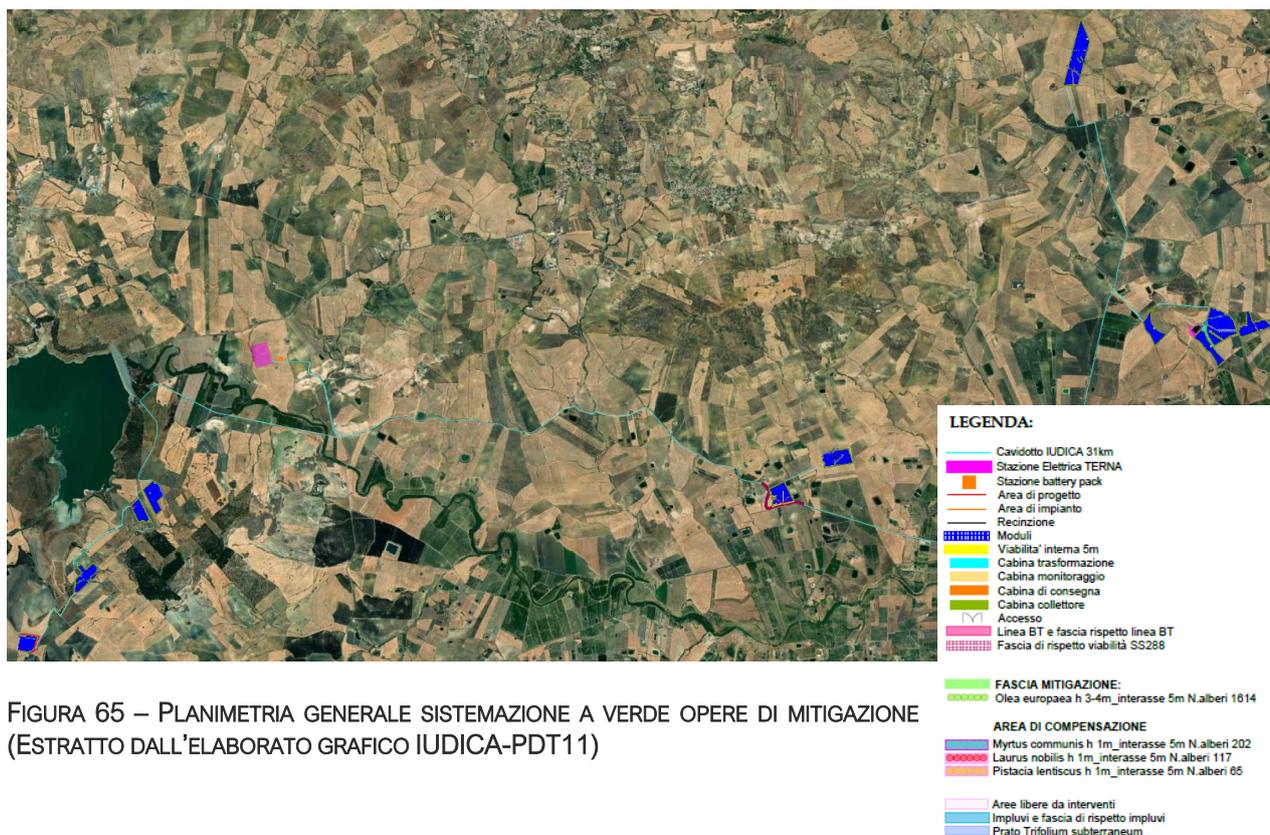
PLANIMETRIA GENERALE SISTEMAZIONE A VERDE OPERE DI MITIGAZIONE (ESTRATTO DALL'ELABORATO GRAFICO IUDICA-PDT11)
